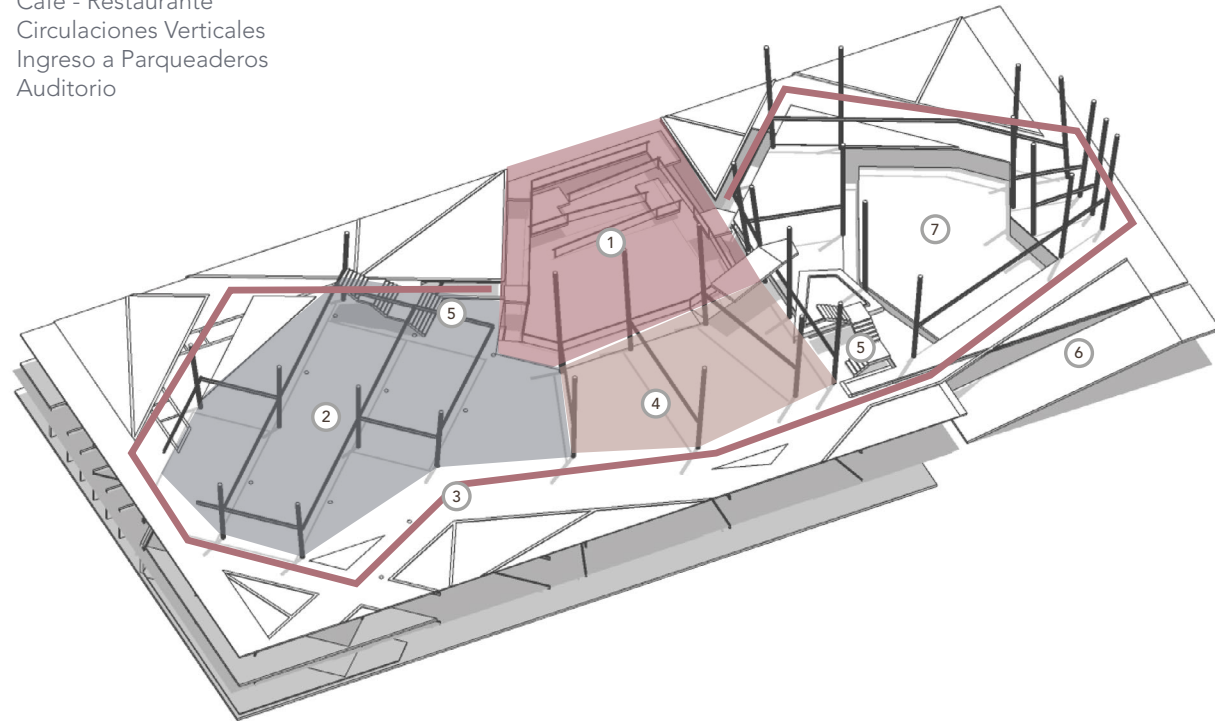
Elementos Constructivos y Espacialidad, Planta Baja
